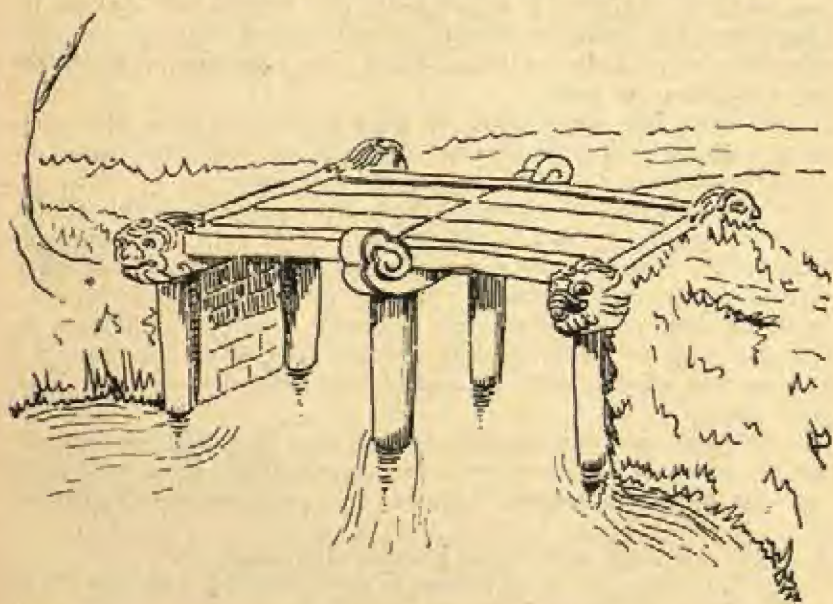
Pont de pierre du village Tiên-Huân, près de So'n-tây. (D'après Y. LAUBIE, *Notes sur un ponceau de pierre*, B.I.E.H., t. IV, fasc. 1-2, 1941, pl. I, p. 124.
